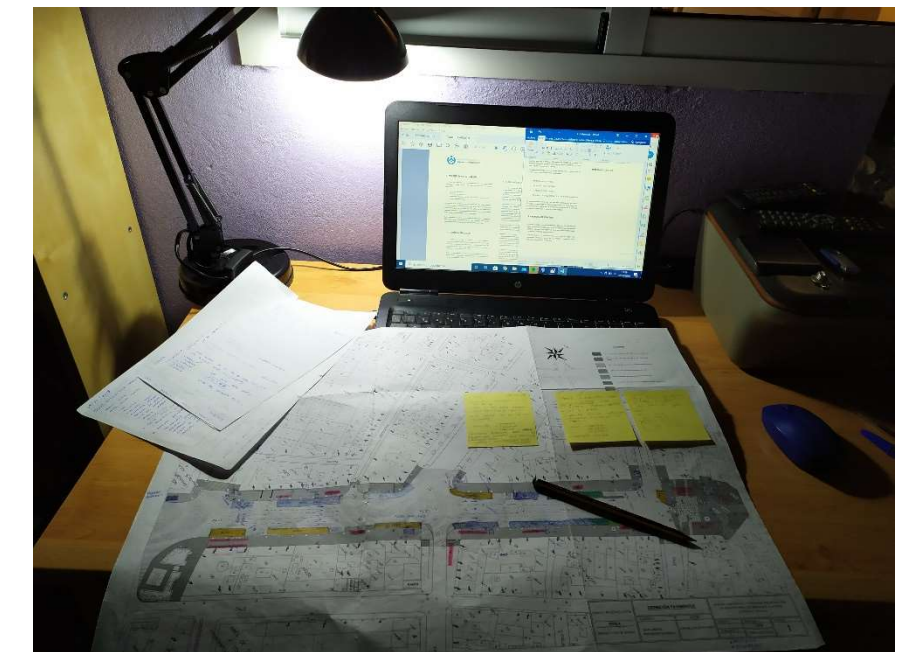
Trabajo de planimetría y documentación en desarrollo
